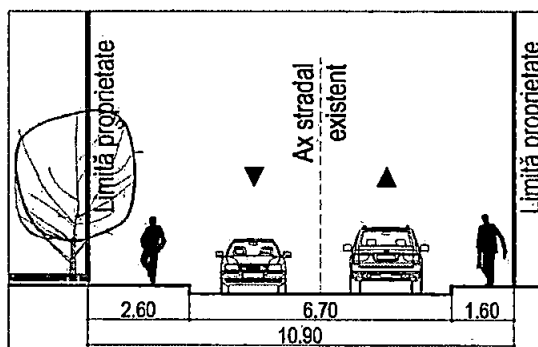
Profil stradal Aleea Daliei (zonă de acces în zona reglementată prin nord)
